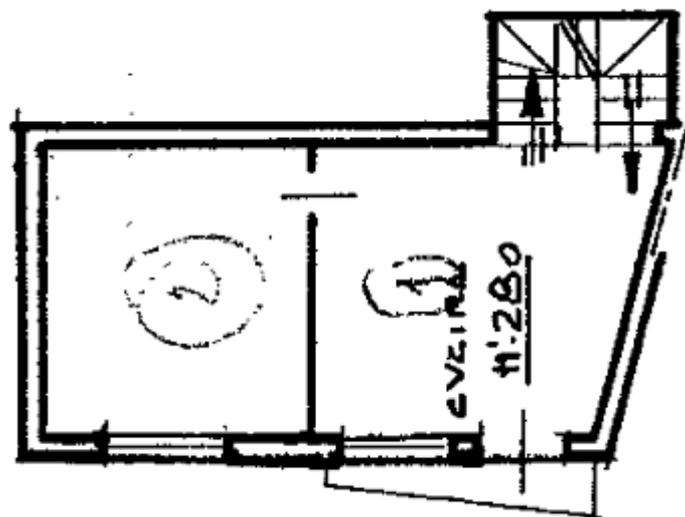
Planimetria catastali dei beni, sub. 1 (p.1).
